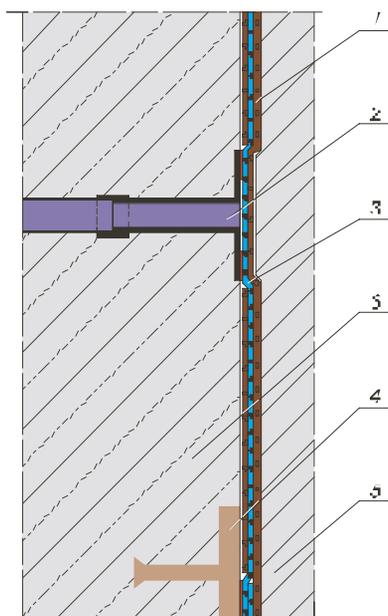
Устройство гидроизоляции стены с контрольно-инъекционной трубкой: 1 – защитная мембрана «Trocal TS» или геотекстиль, прикрепленный механически; 2 – контрольно-инъекционная трубка; 3 – гидроизоляционная мембрана «Trocal»; 4 – соединительный ПВХ-профиль; 5 – защитная кирпичная кладка; 6 – конструкция стены
